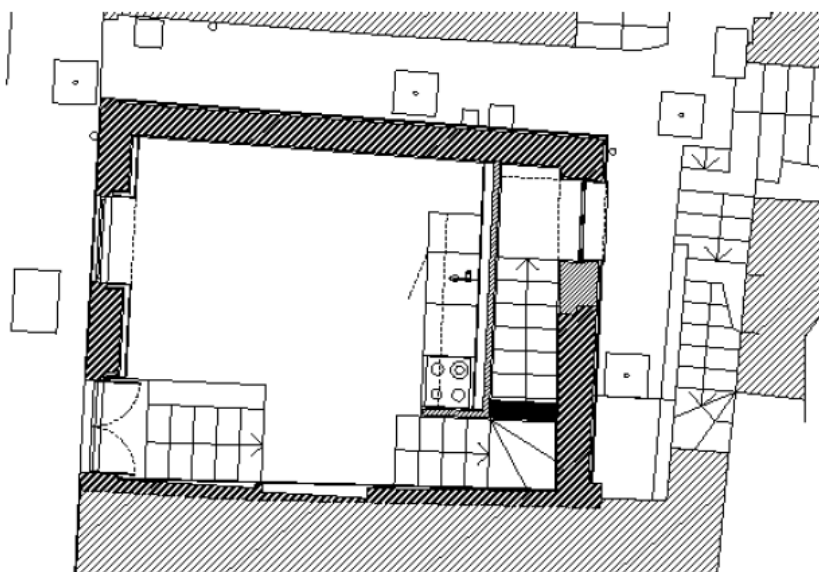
Planta do edifício Cedofeita: Piso 0
